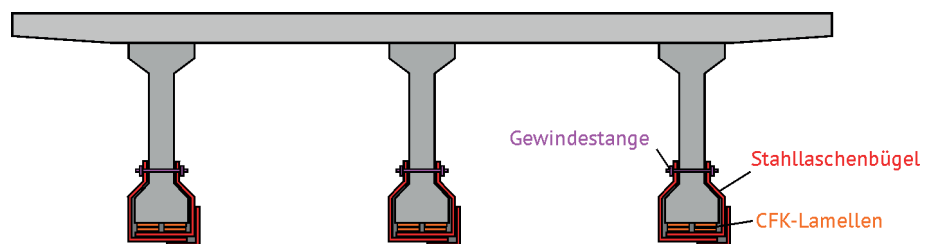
Mögliche Verstärkungen mit aufgeklebter Bewehrung und zusätzlichen Stahllaschenbügeln zur Herstellung eines Ankündigungsverhaltens bei spannungsrissskorrosionsgefährdeten Bauteilen, aus [6]
